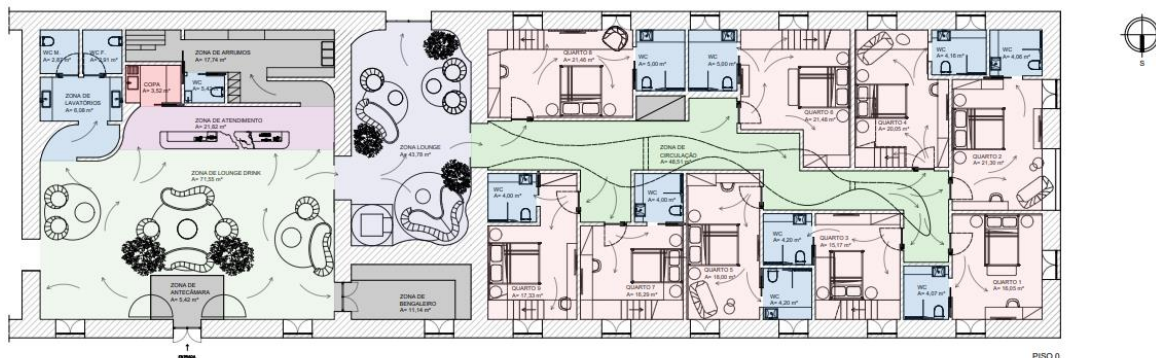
Planta de Zonamentos e Circulação, Piso 0
